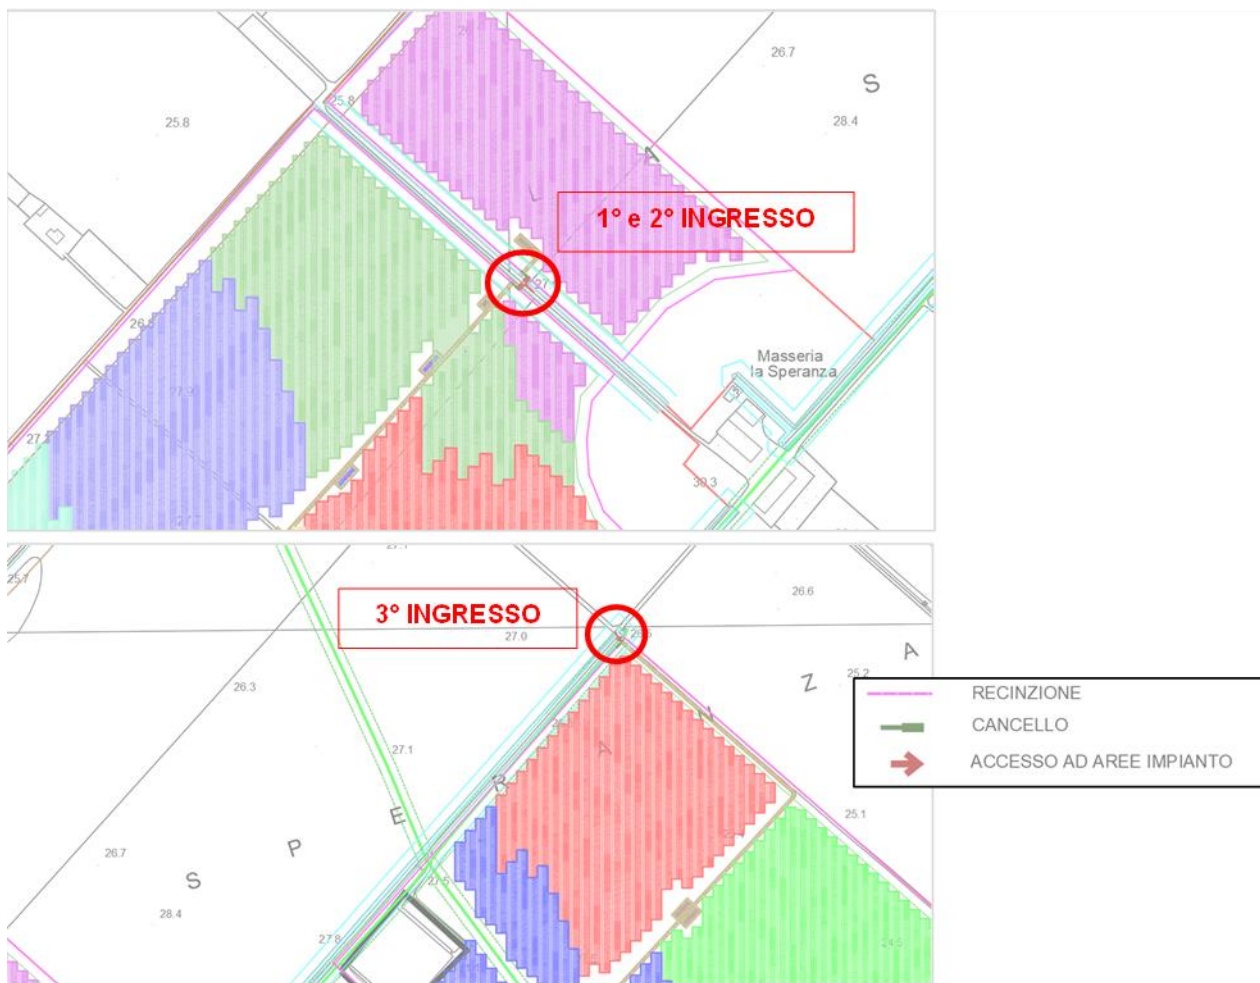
Individuazione dell'area di impianto con indicazione dell'ubicazione degli ingressi all'impianto
